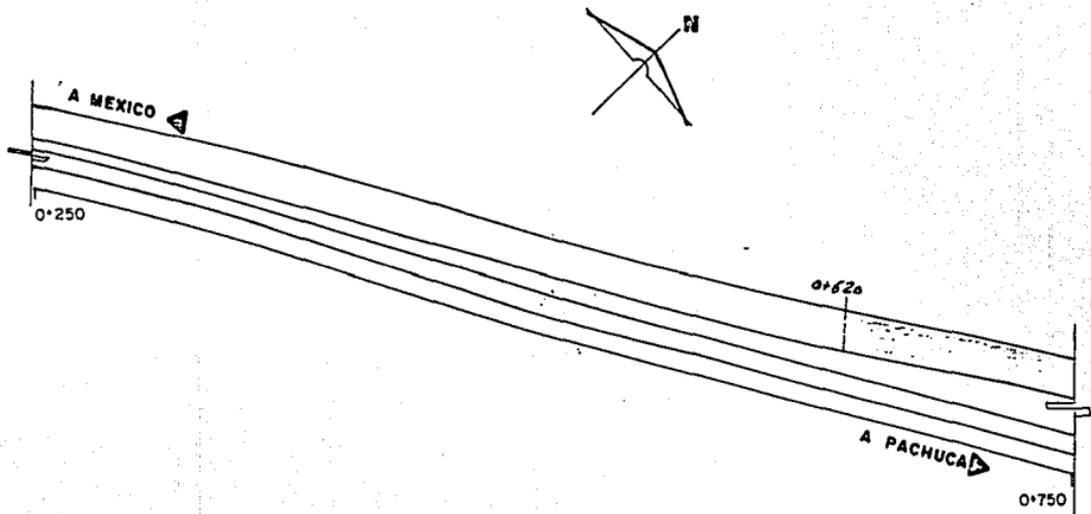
a.- Croquis de planta general de la obra en su primera etapa.
